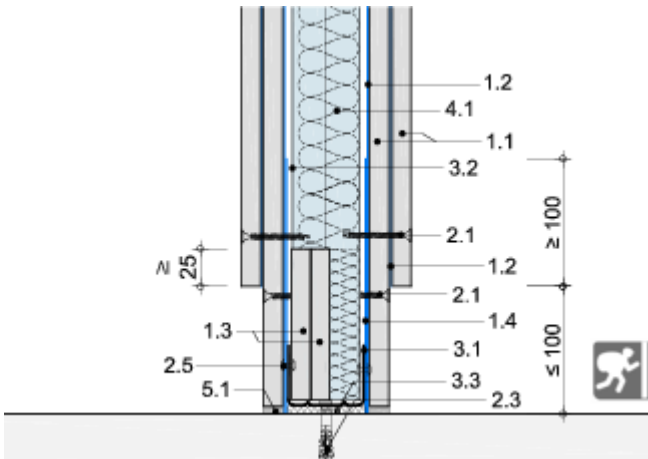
Fußpunkt Doppelständerwand RC 3
